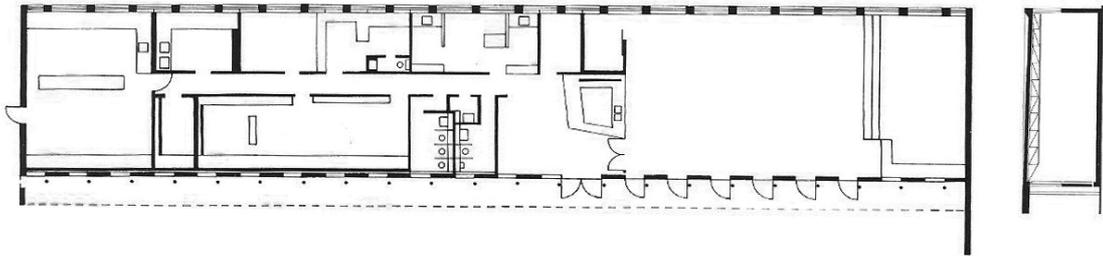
| Planta Pincus Building [BÜTTIKER]
